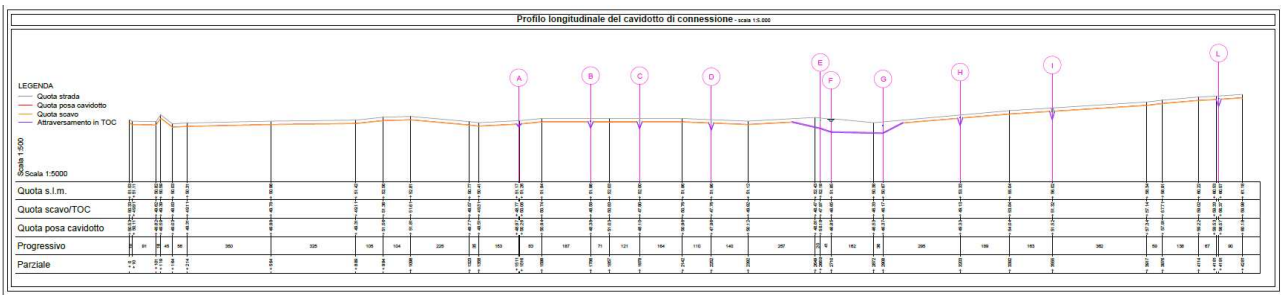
Stralcio elaborato "MRR-CIV-TAV\_036\_02\_Studio attraversamenti" - Profilo longitudinale cavidotto di connessione
